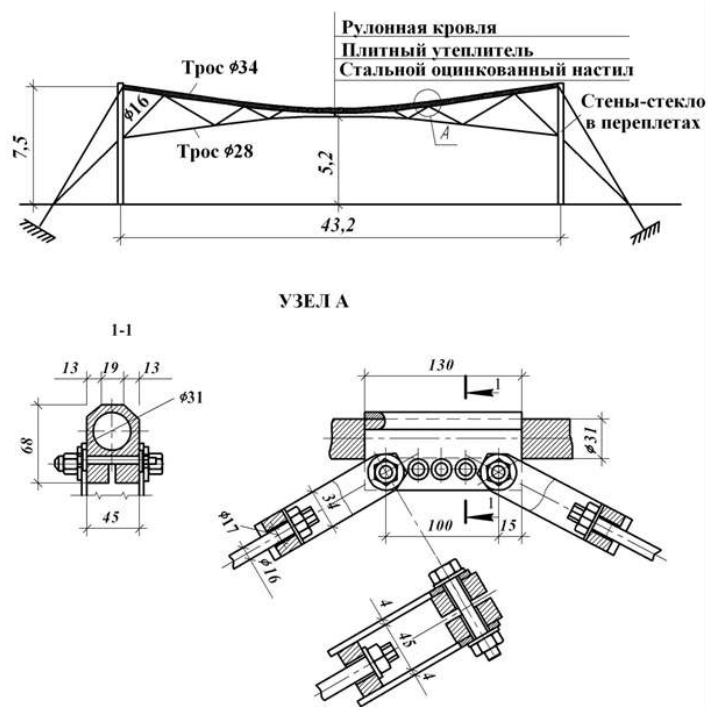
Тросовая ферма в прямоугольных в плане зданиях.
